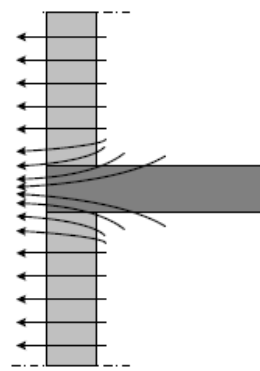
Ponte térmica devido à ligação da laje com a fachada.
